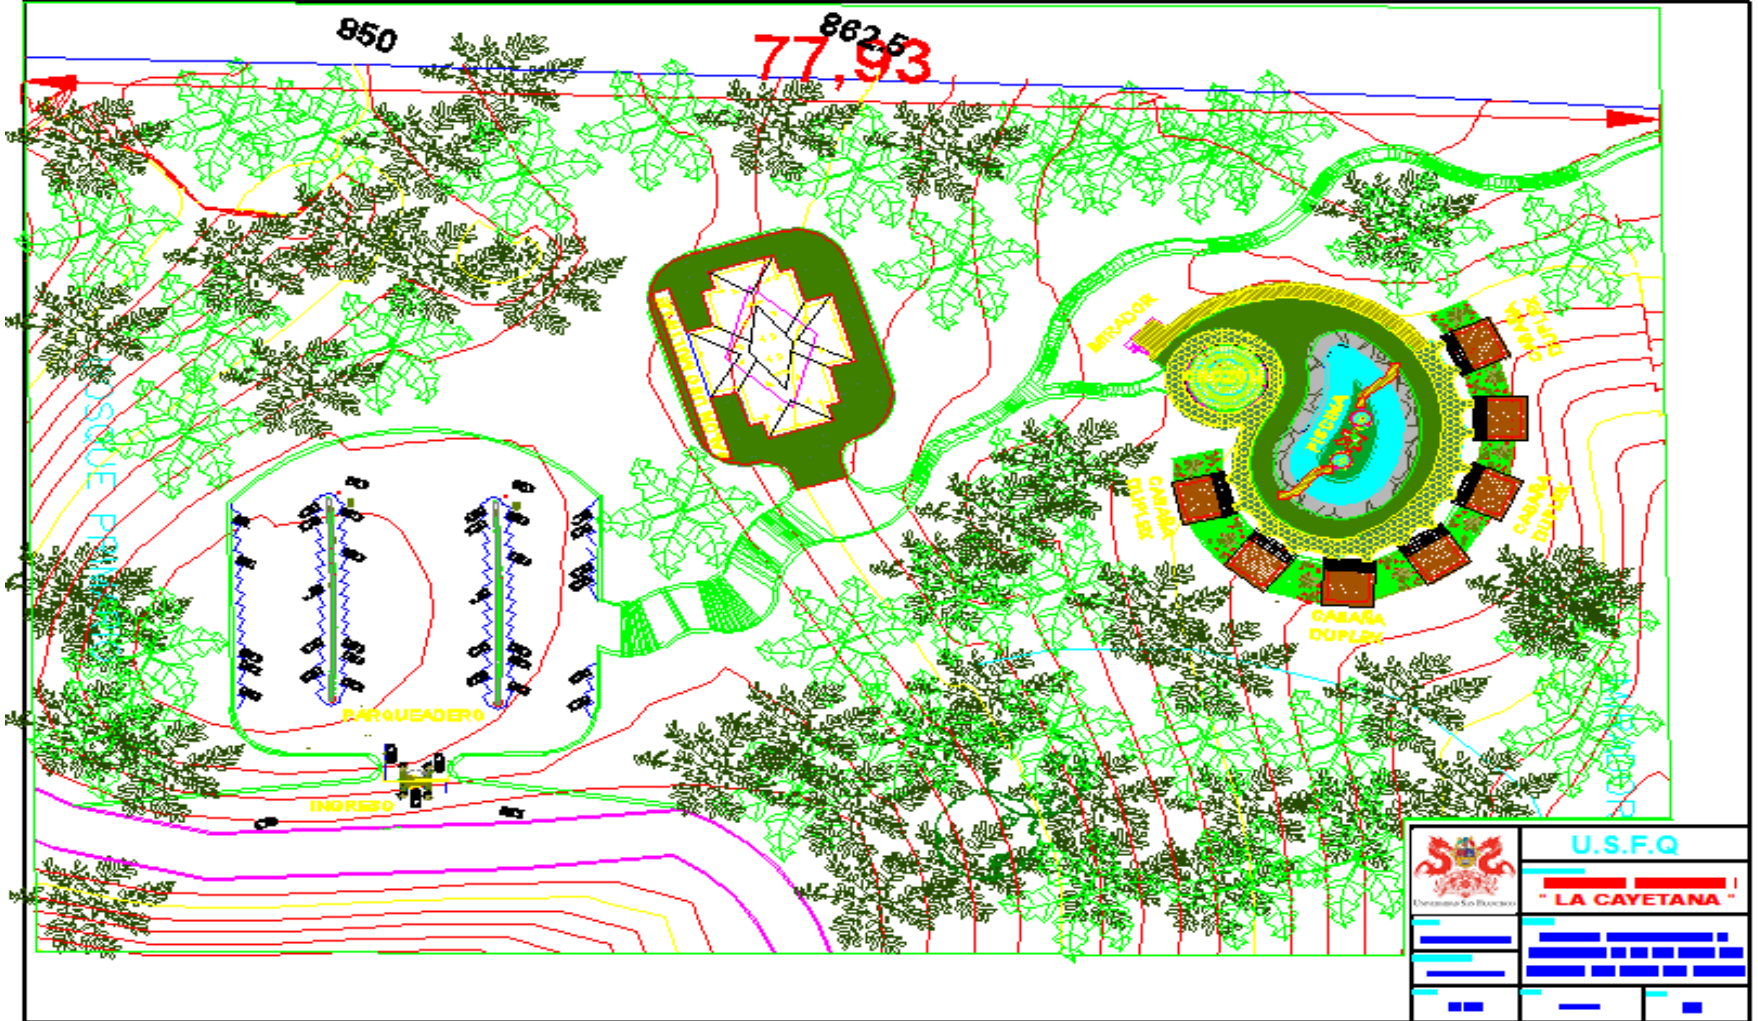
Levantamiento topográfico y detalle de implantación del proyecto.
